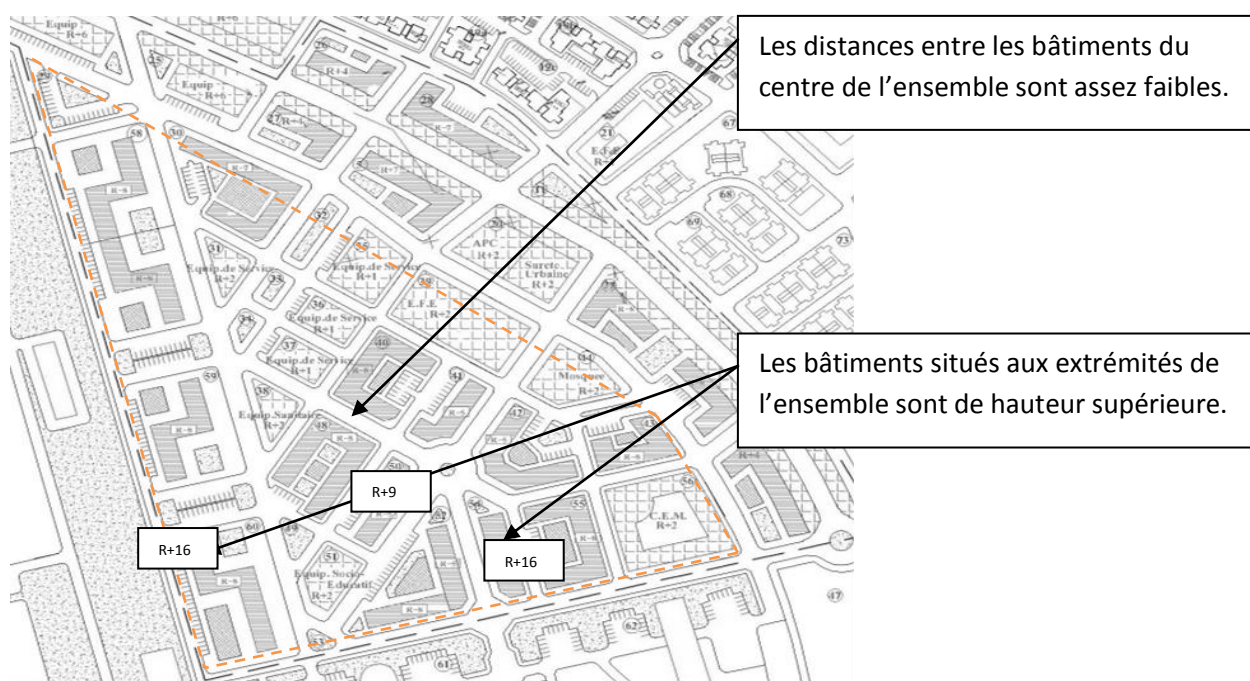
plan de masse montrant les hauteurs des bâtiments, leurs positions, et les distances laissées des uns par rapport aux autres.
